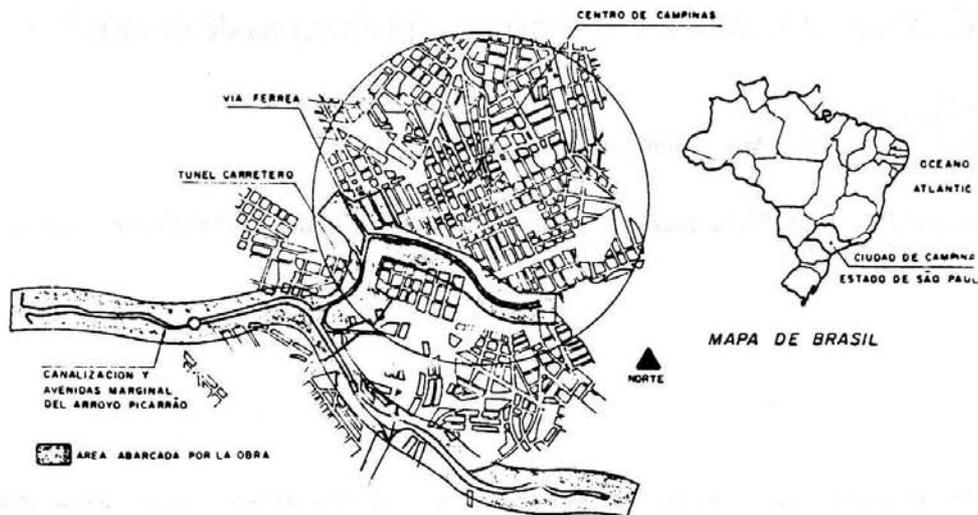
PLANTA GENERAL DE LA OBRA
